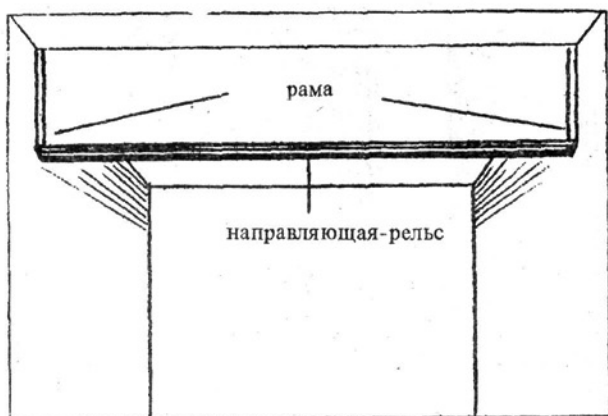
Рельс для перегородки высотой в стандартную дверь
